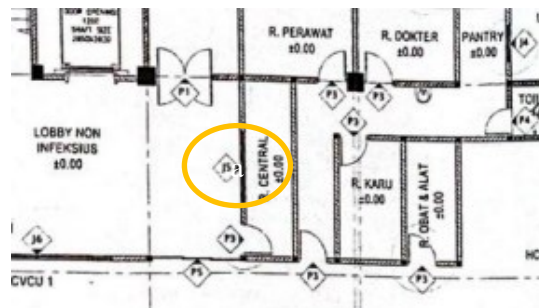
Denah Rencana Jendela Tipe J4.
